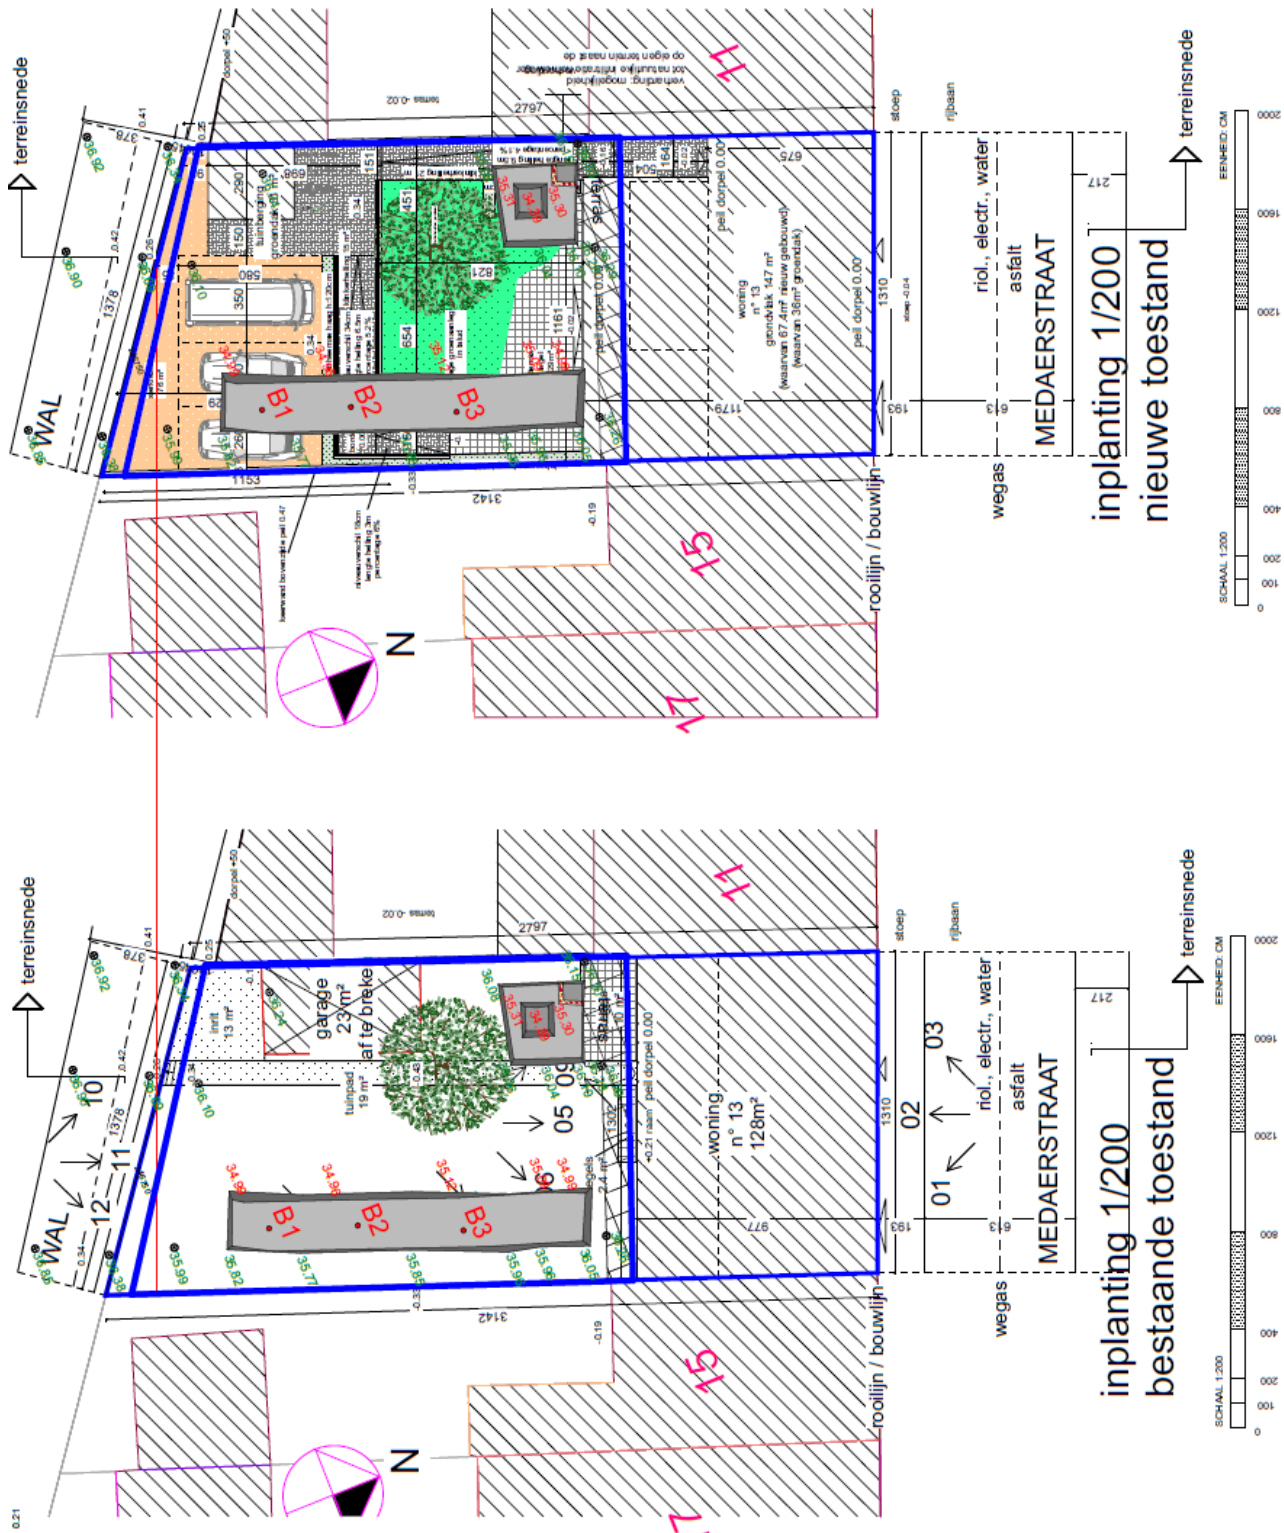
Projectie van het alle-sporenplan op de opmetingsplan bestaande toestand en het plan nieuwbouw en nieuwe aanleg
